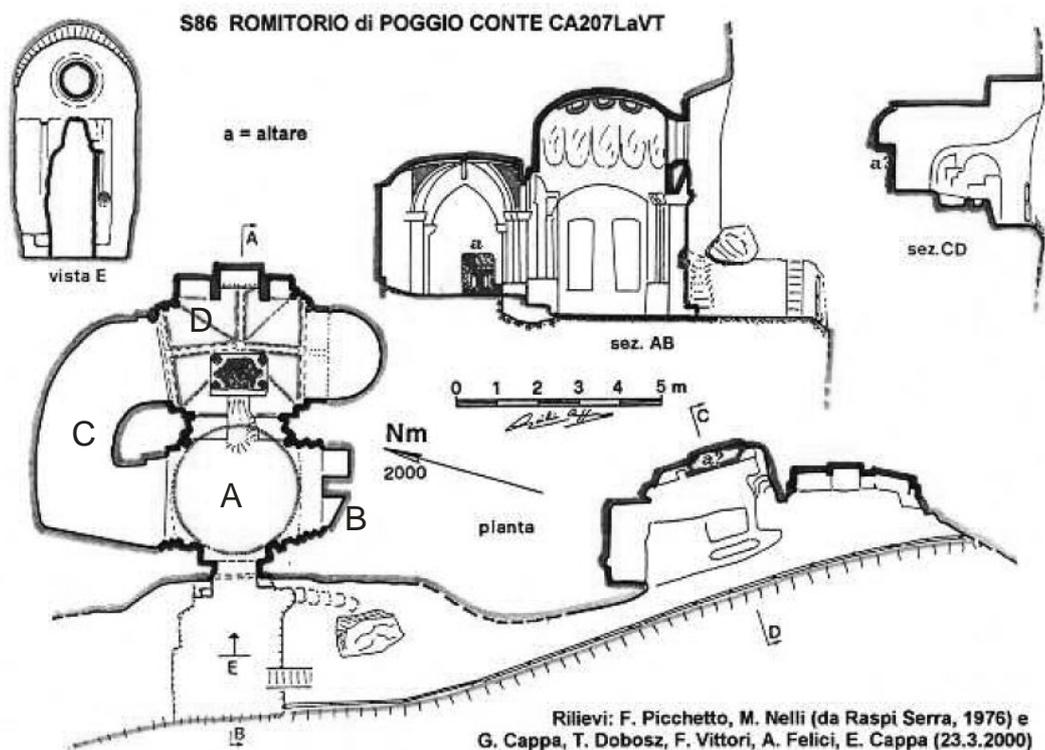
Chiesa rupestre di Poggio Conte, pianta e sezioni (fonte: Cappa 2008, modificato dall'autore).
